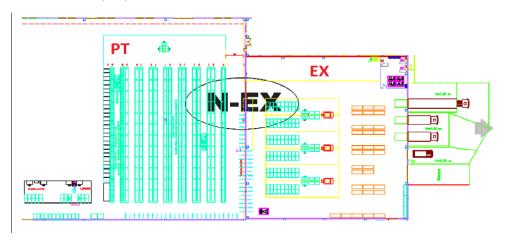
LayOut del almacén PT y EX. Fuente: proporcionada por la empresa.
